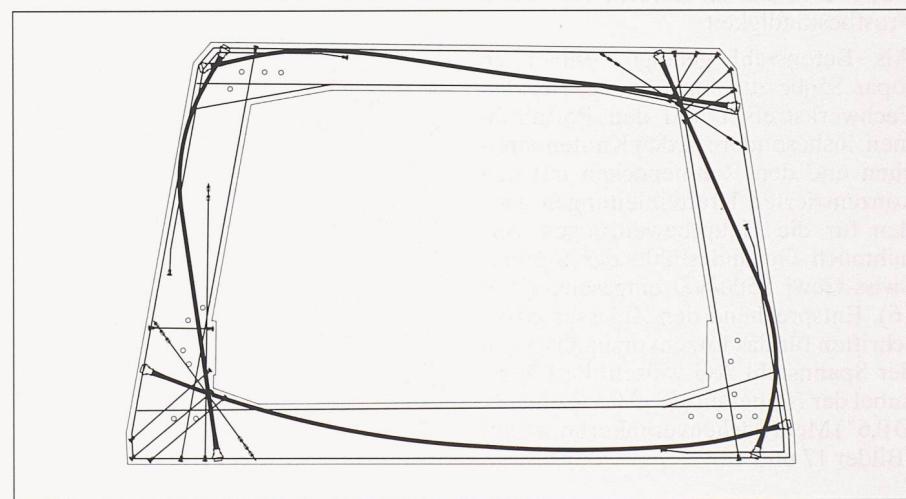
Schematische Darstellung der Hauptbewehrungsführung im Portalrahmen (Ing.büro H. Rigendinger)
